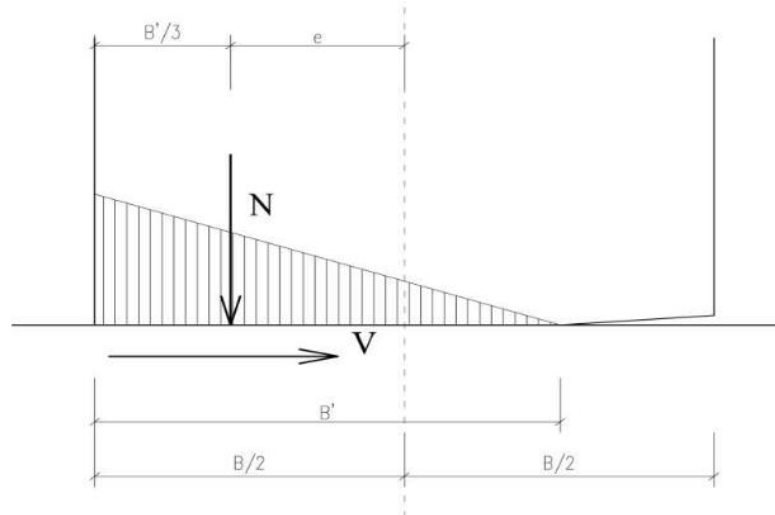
Zona efectiva de corte en pilares Fuente: Savino, 2012
